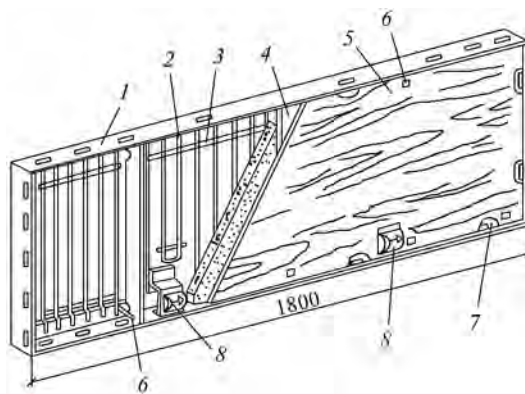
Греющий щит опалубки: 1 — каркас щита; 2 — греющий кабель; 3 — скоба крепления кабеля; 4 — утеплитель; 5 — защитный кожух; 6 — крепления кожуха; 7 — вырез для установки и крепления щитов; 8 — вилочный разъем щитов
